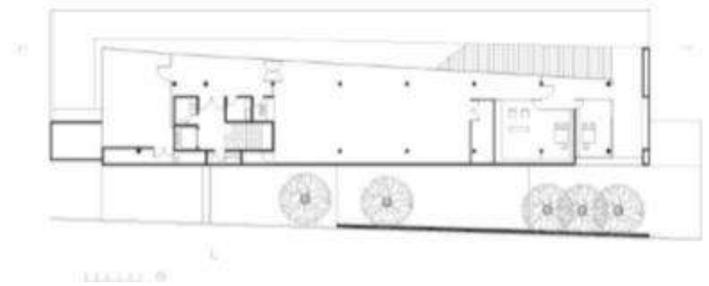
Planta Centro Cultural Vladimir K. Tomado de Archdaily.
